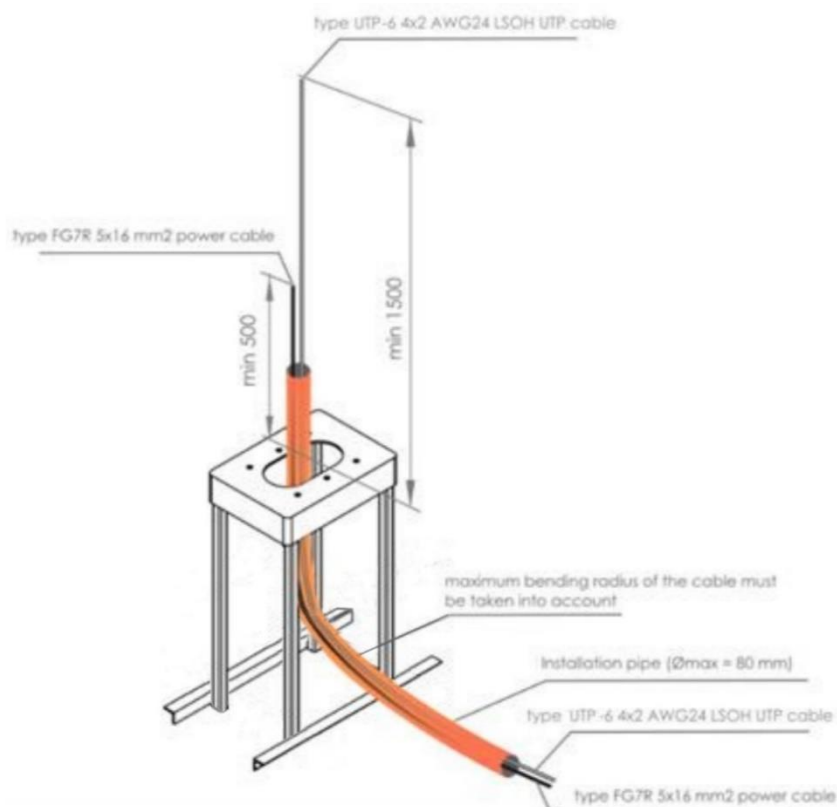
posizionamento del tubo di installazione e inserimento dei cavi
